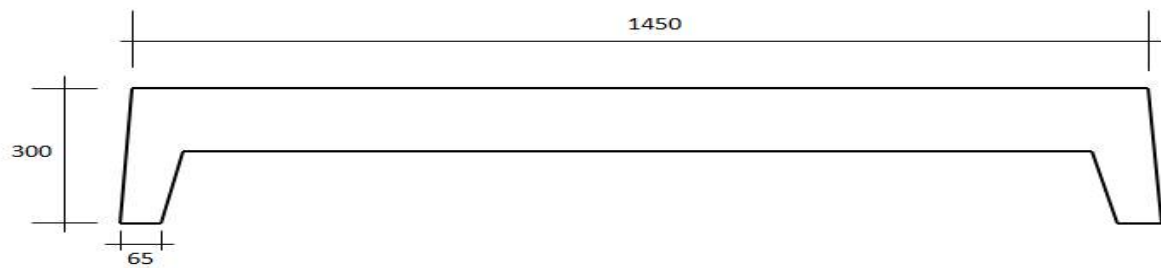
Схема перерізу досліджуваної ребристої залізобетонної плити.
